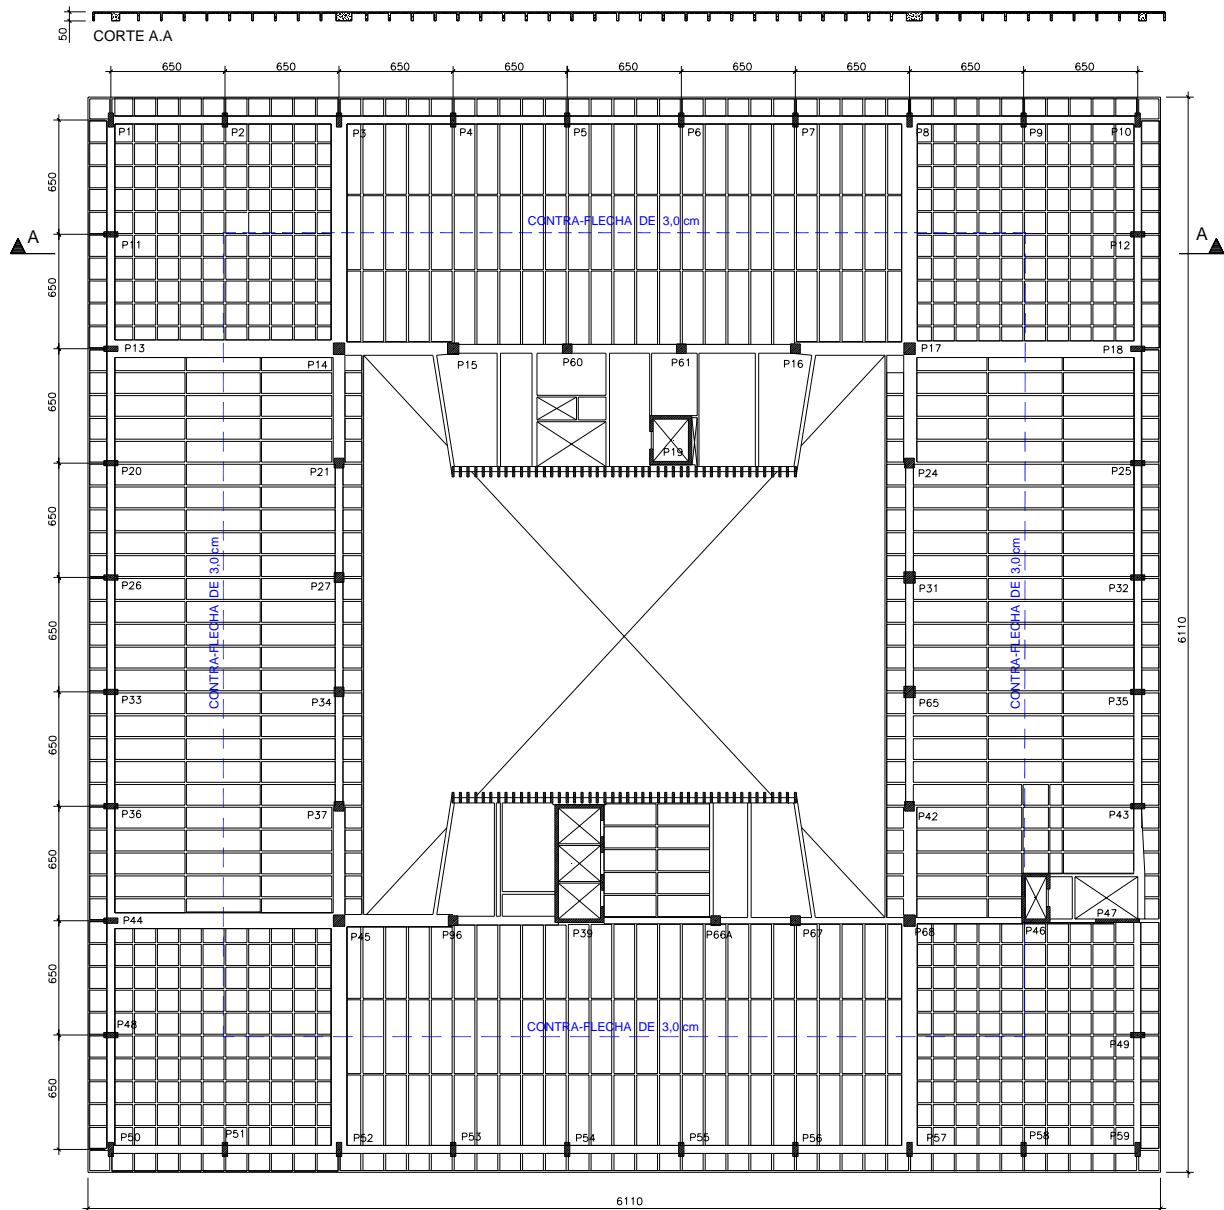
Fôrma do 4º. e 5º. pavimento do Palácio da Justiça (sem escala)
